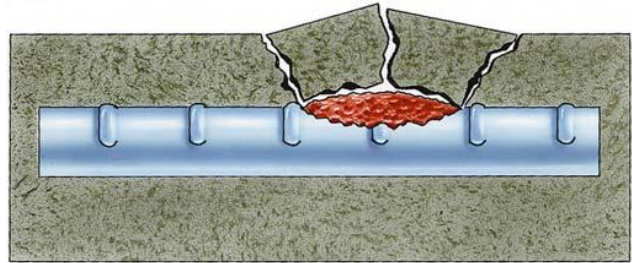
Rotura recubrimiento por corrosión de armadura. [17]
